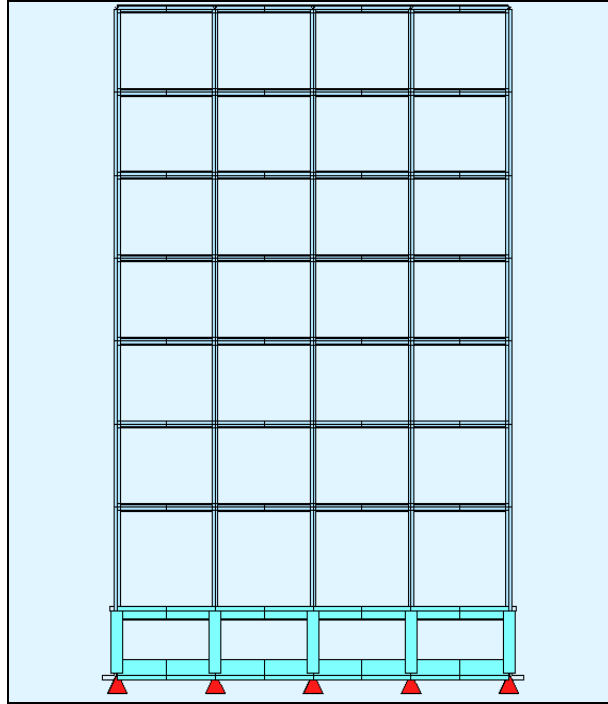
Ανατολική τομή κτιρίου TRUSS 2
